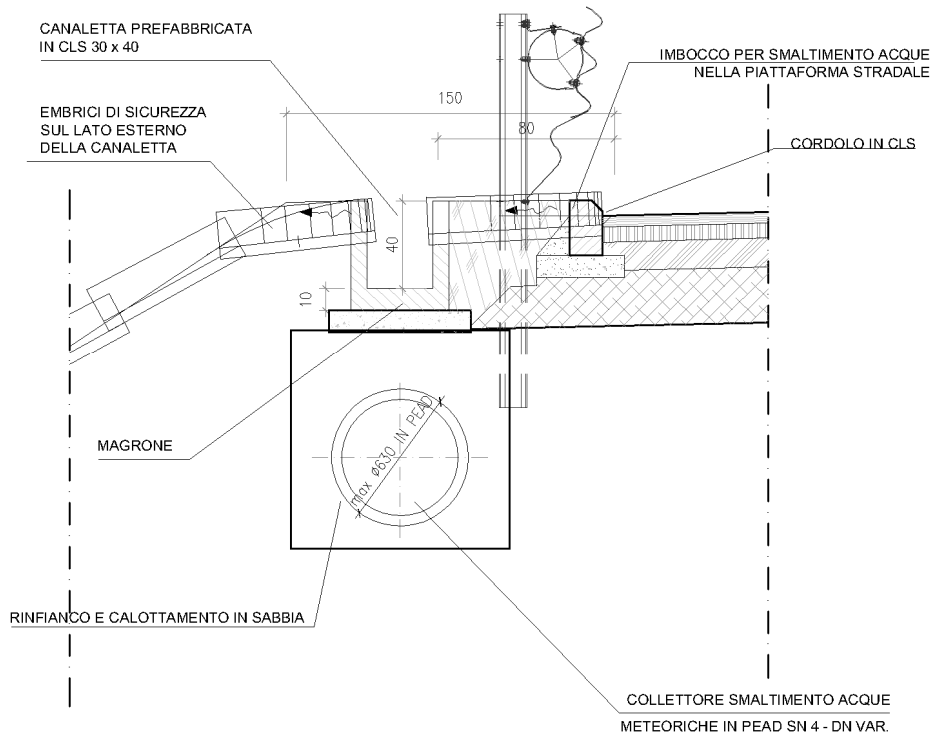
Particolare del sistema di raccolta di tipo chiuso – Vista in sezione
